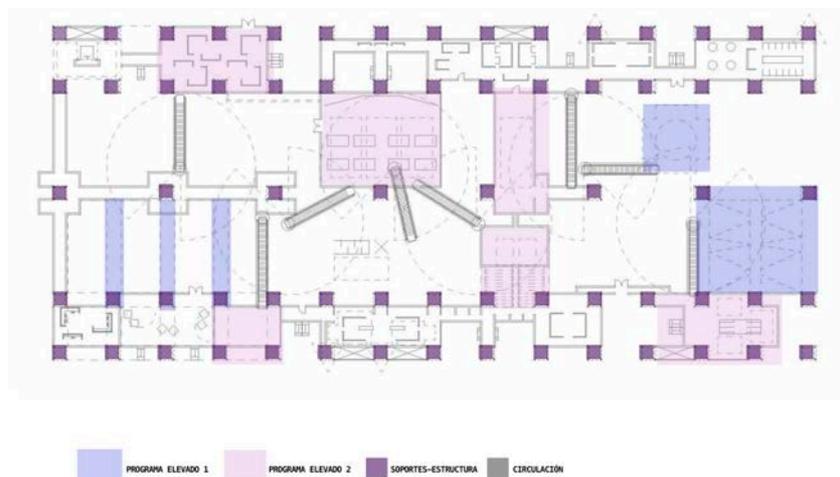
Corte transversal, Fun Palace, Volúmenes Elevados y estructura. Ilustración propia. Planos cortesía de cca.
